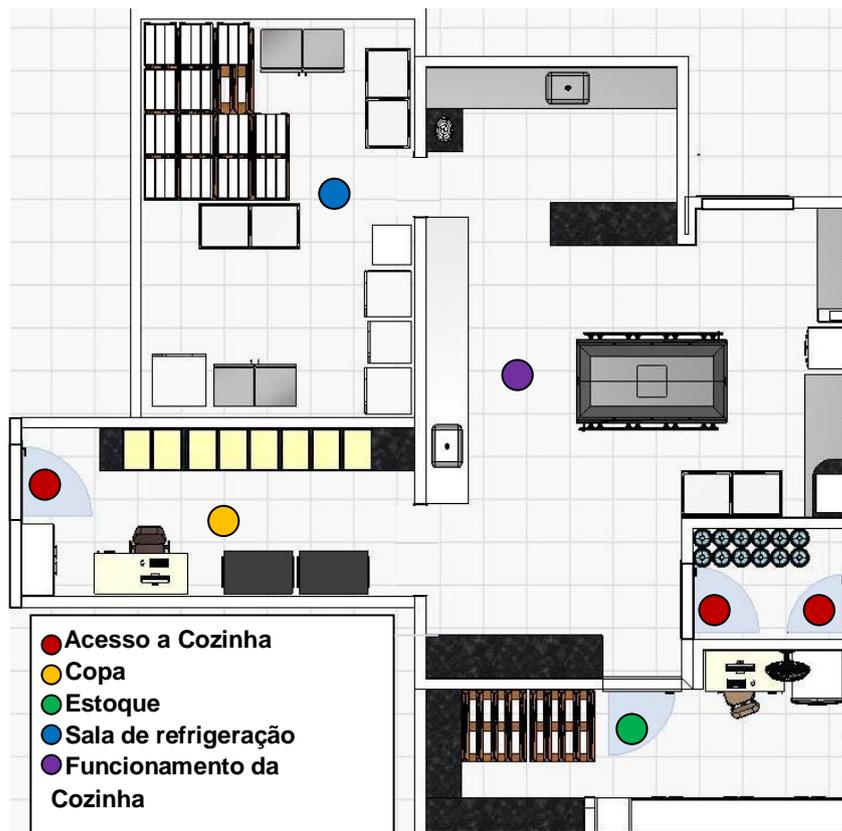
Planta baixa dos setores da cozinha hospitalar analisada
